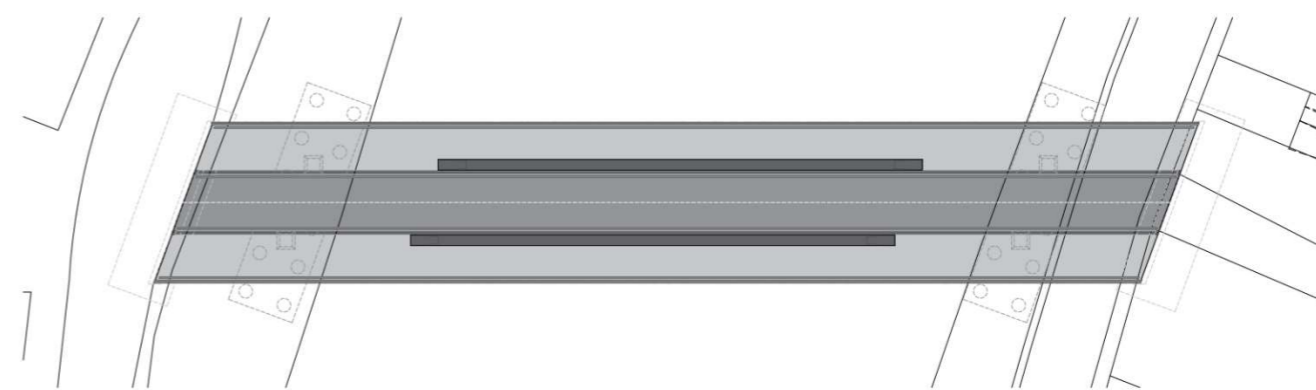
Vista en planta del puente (fuente: elaboración propia)
